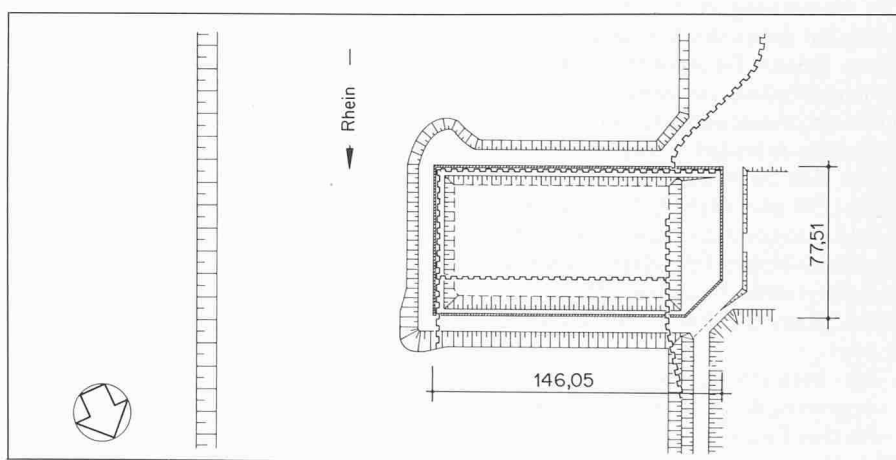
Lageplan mit Baugrube, 1. Bauabschnitt
